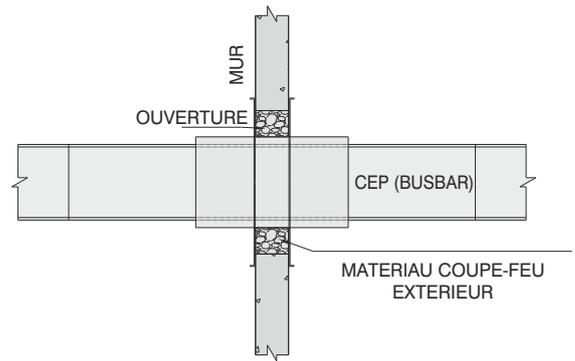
CROISEMENT DU MUR AVEC BARRIERE COUPE-FEU
